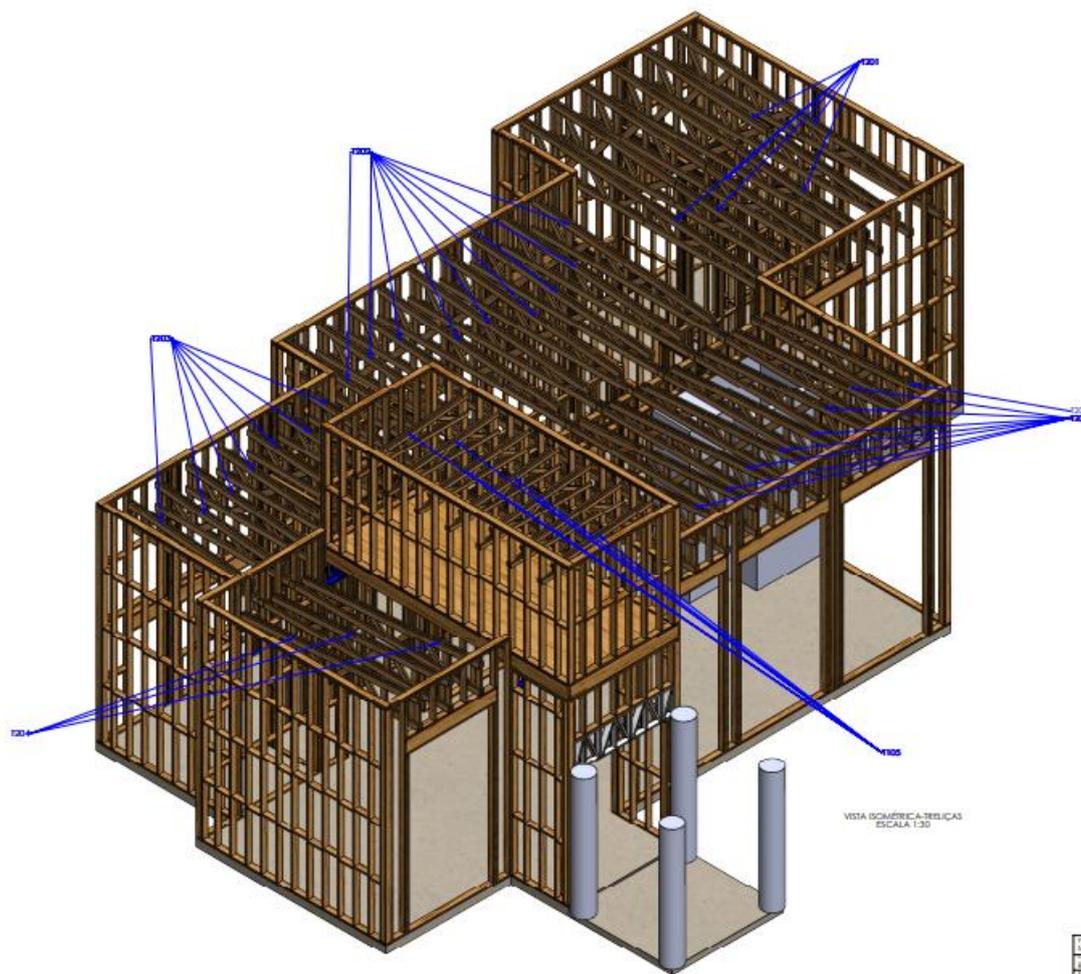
Projeto estrutural de *Wood Frame* da Construtora Frame System.
